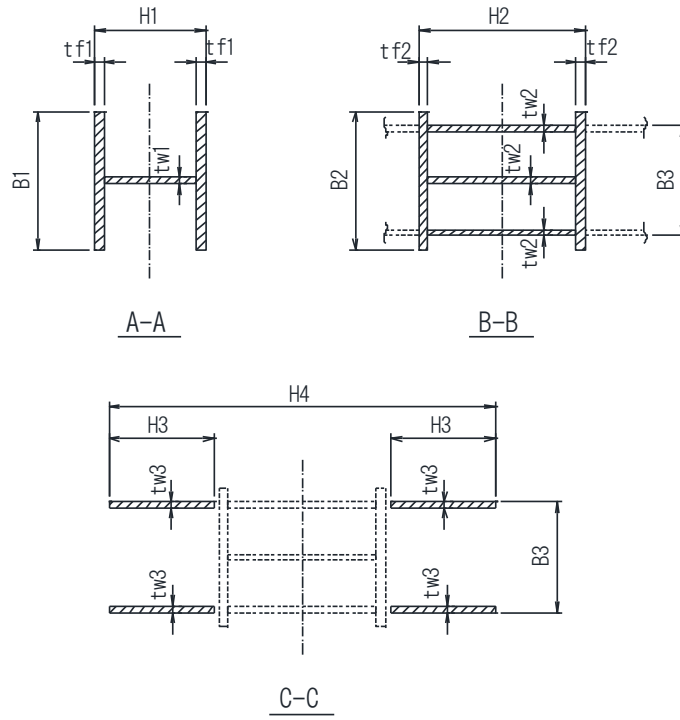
(1) 支持点アームの構成断面 (単位: mm)
